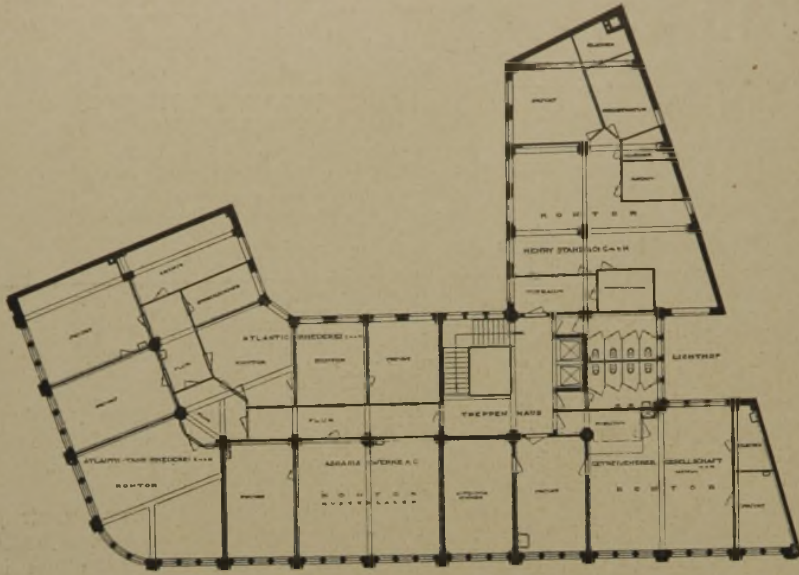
Grundriß des I. Obergeschosses. (1:400.)
